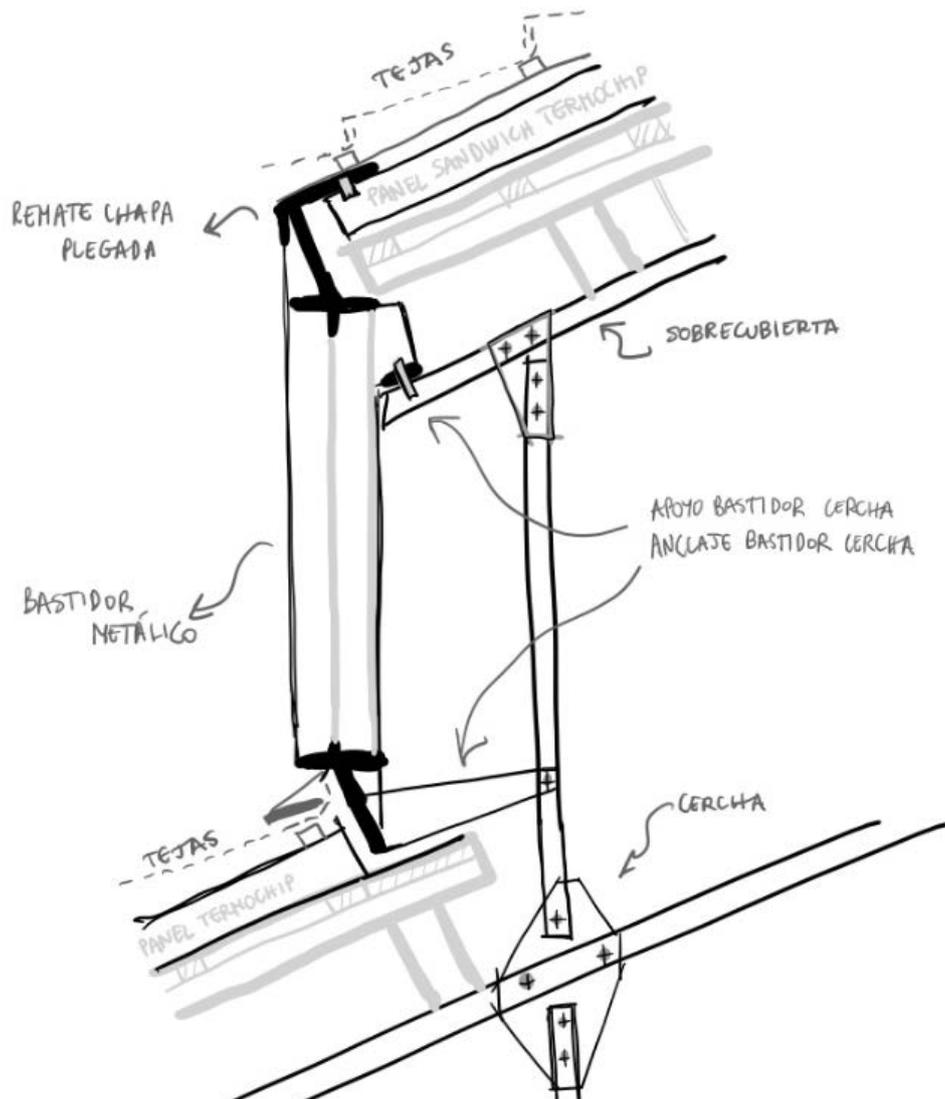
El diseño del bastidor de los lucernarios y los anclajes con el sistema estructural de la cubierta. Esquema cuya referencia aparece en el plano E.02 sobre los detalles constructivos del Proyecto de Consolidación. Estos planos están firmados por Eduardo de Miguel, Rafael Ferriols y Leandro Feliu en julio de 2015. Fuente: elaboración propia.
